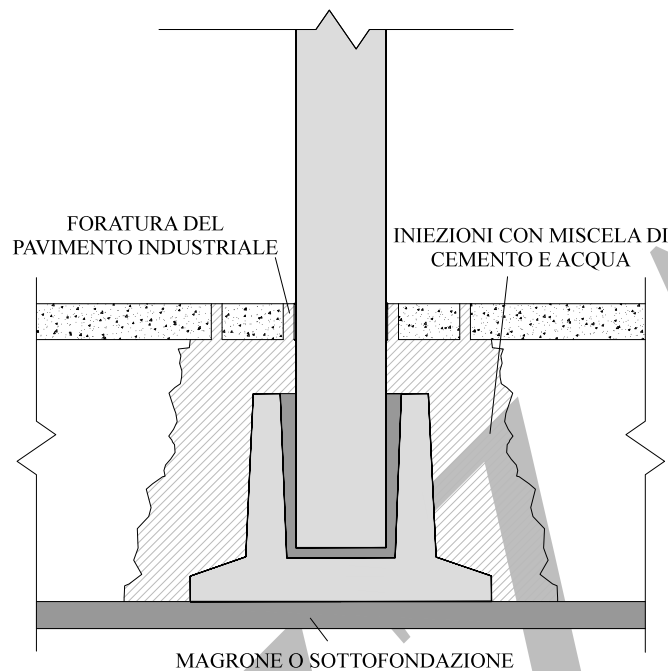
Consolidamento del terreno circostante la fondazione mediante iniezioni con miscele cementizie a bassa pressione
